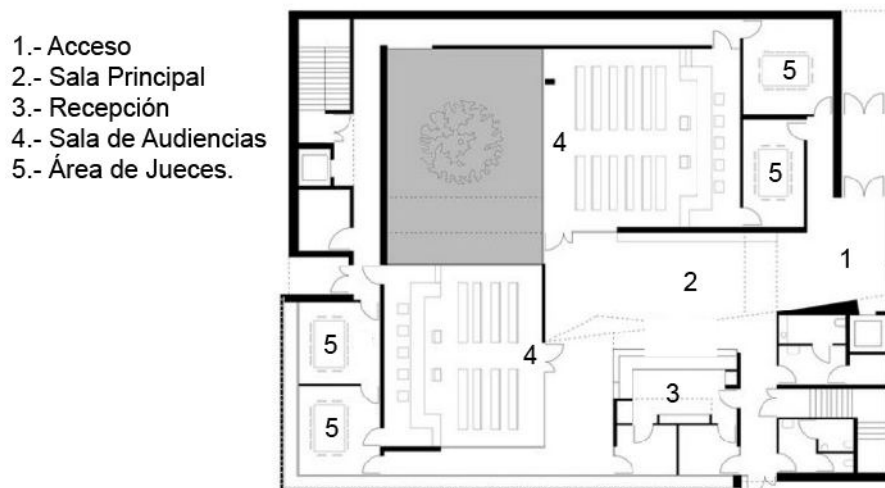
Planta arquitectónica del Proyecto Corte Regional en Montmorency. Fuente archdaily.mx manipulado por el autor. Sin escala.
